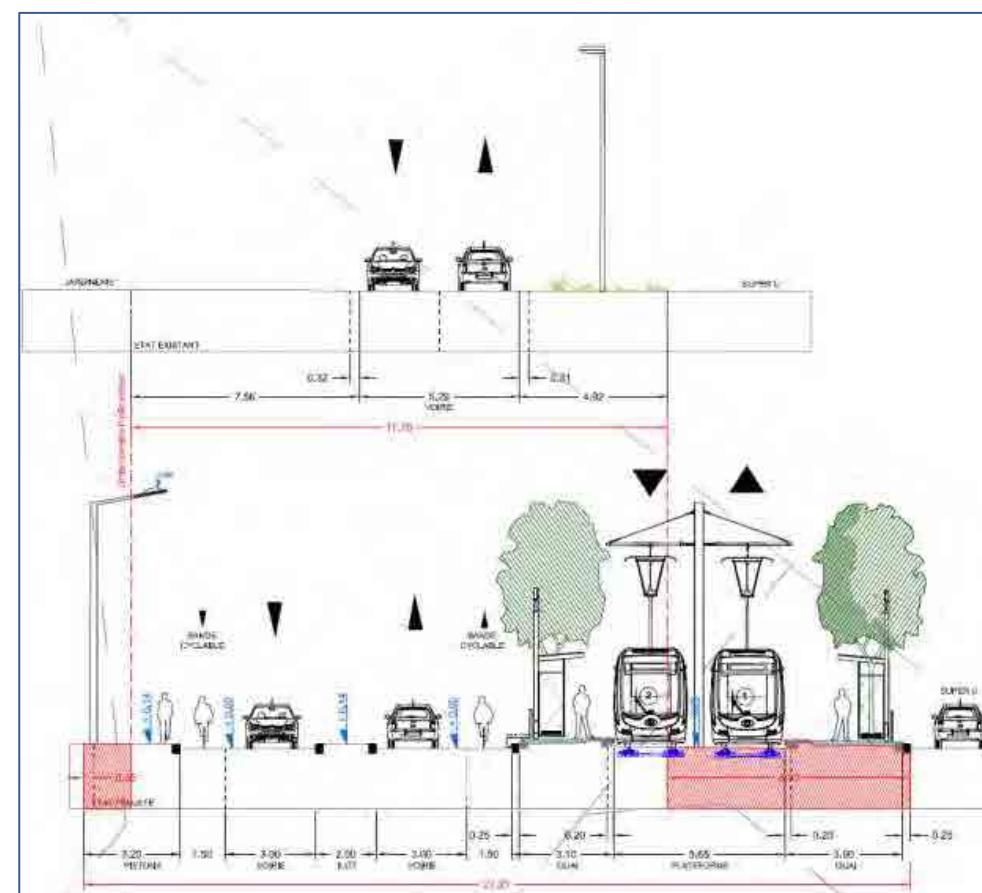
Schéma en coupe de la future station de tramway de Cantinolle
